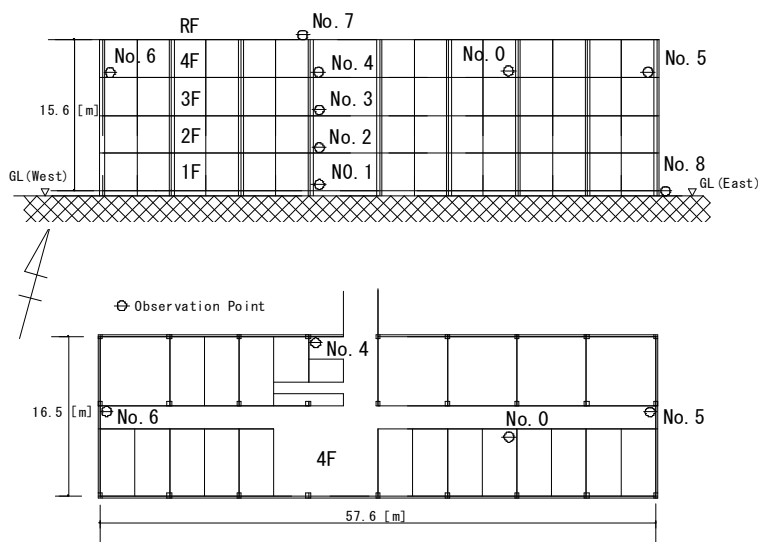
観測対象構造物 (上) 断面図 (下) 4F 平面図
